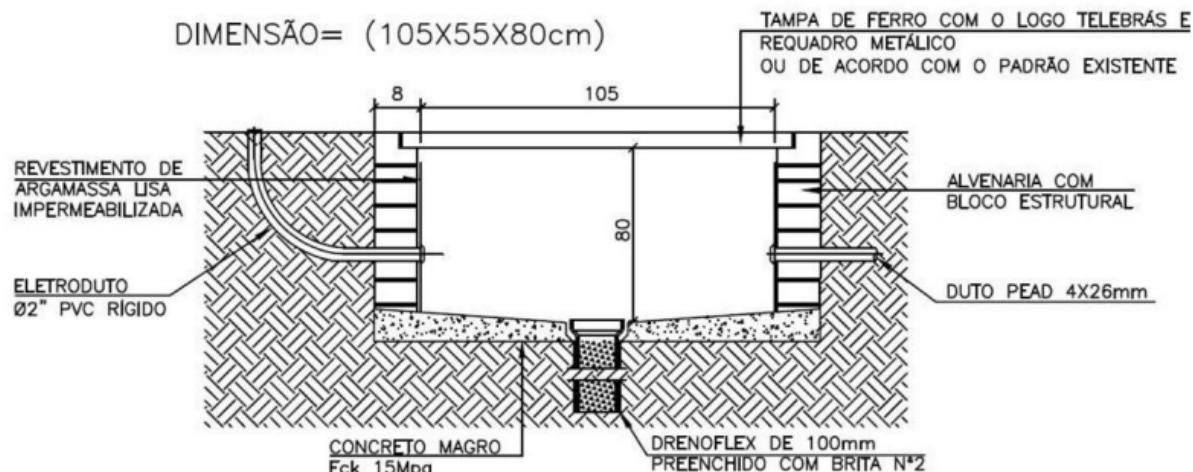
Modelo de caixa subterrânea tipo R2 de concreto.
